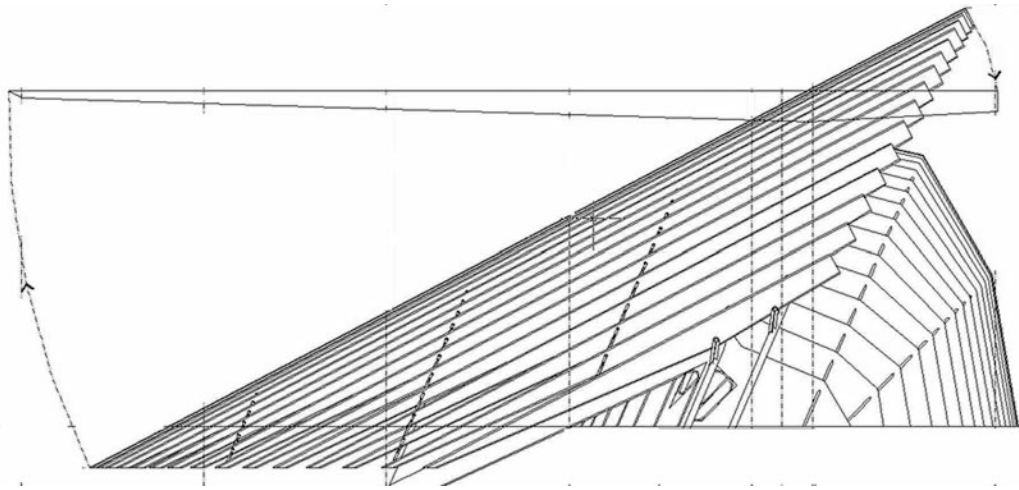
Alzado del P.E.C. con la cubierta móvil cerrada
